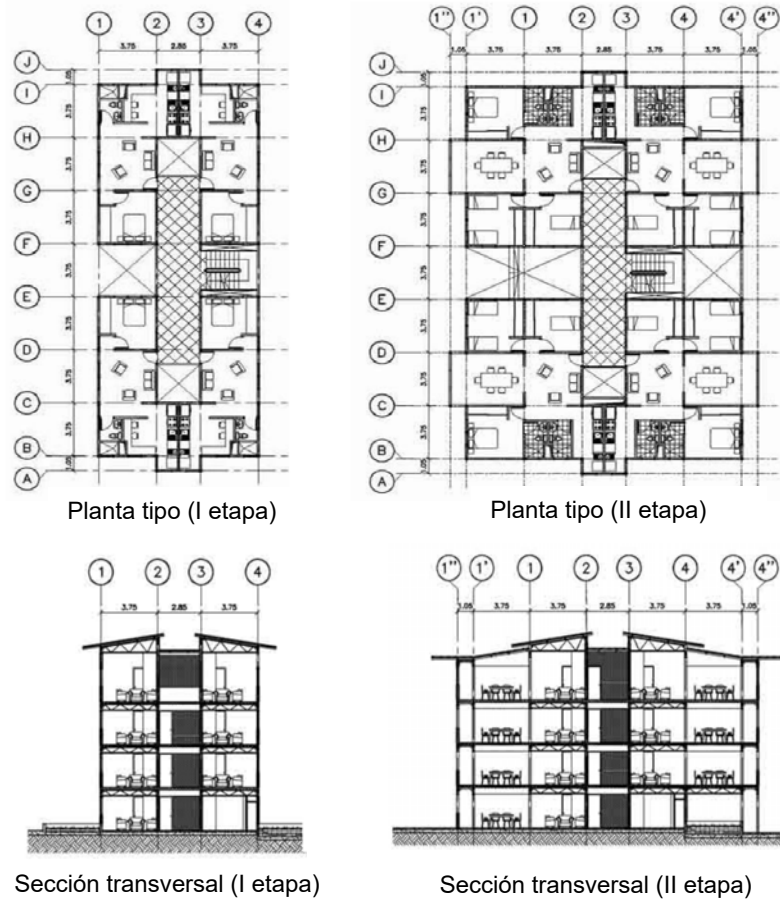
Plantas y secciones de la vivienda propuesta (Sistema SIEMA-VIV). (Hernández R., 2008)
